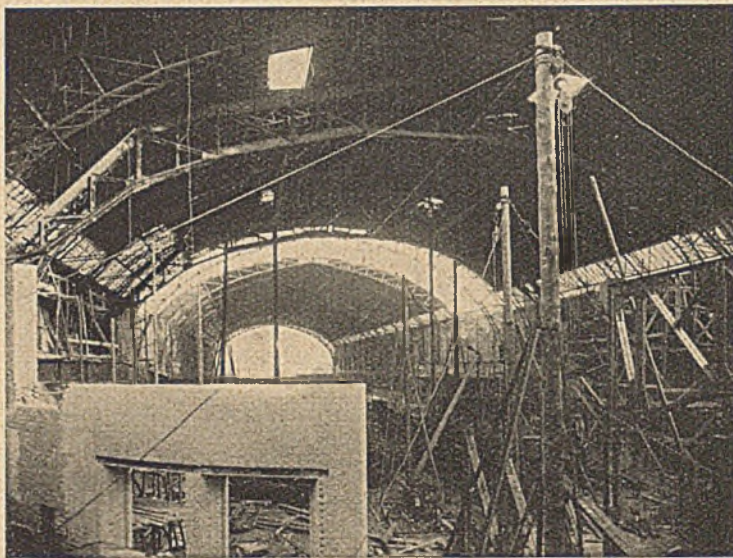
Einbau der neuen Bogenträger und Einblick in die alte Bahnhofshalle.
